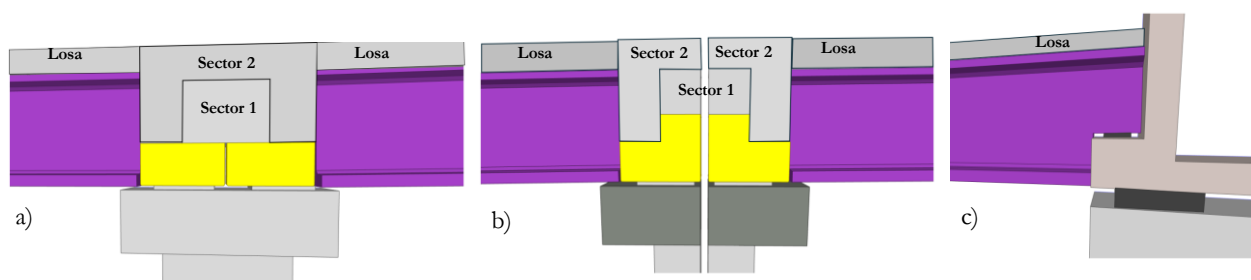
Secuencia constructiva jácenas JP: apoyo de forjado en zona intermedia (a), en junta (b) y en cajón (c).
